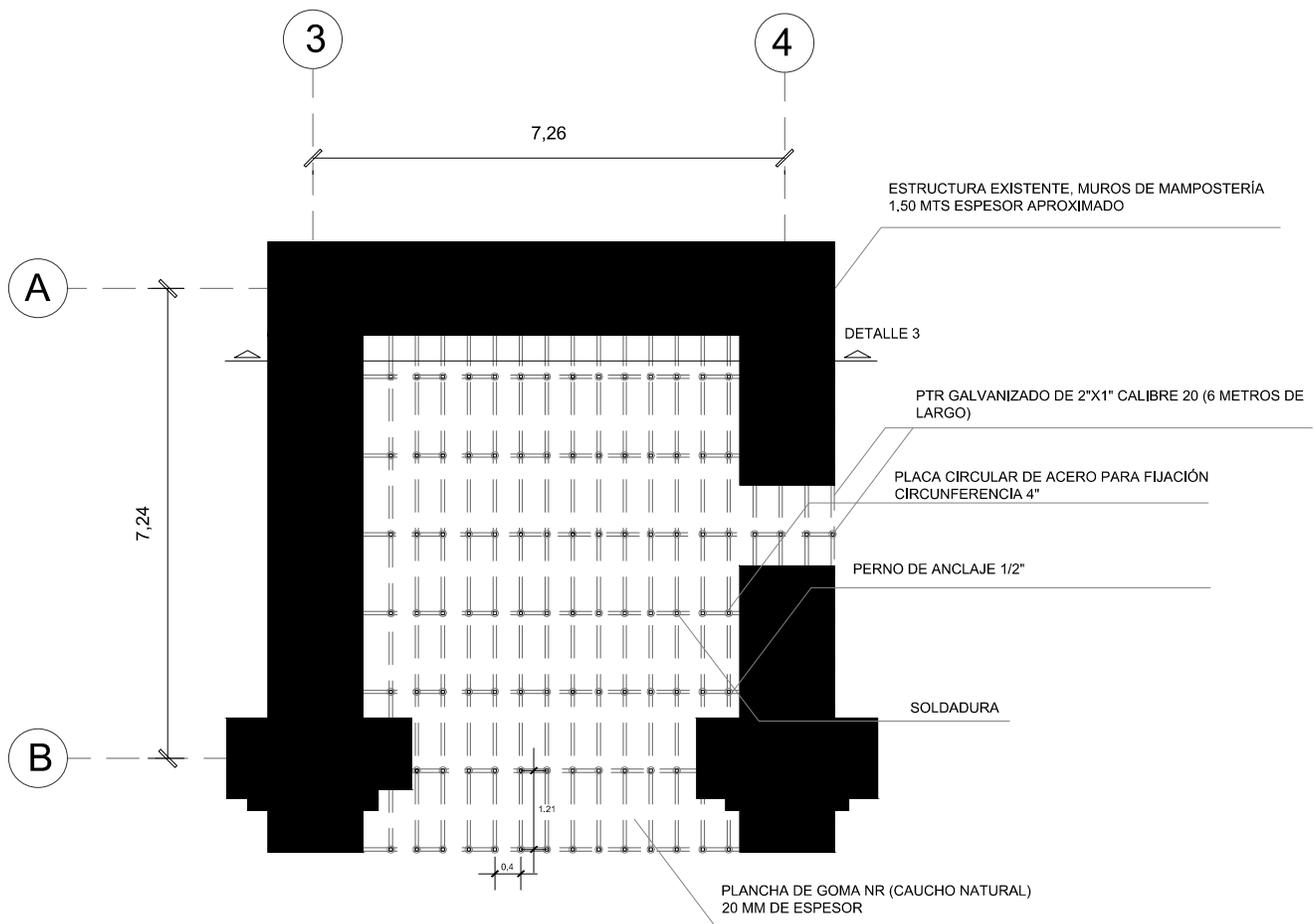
Detalle 1. Distribución de PTR para bastidor entre ejes 3-4, A-B
